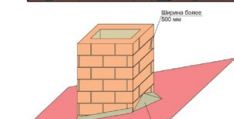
Примыкание кровли к трубе дымохода шириной более 500 мм.
